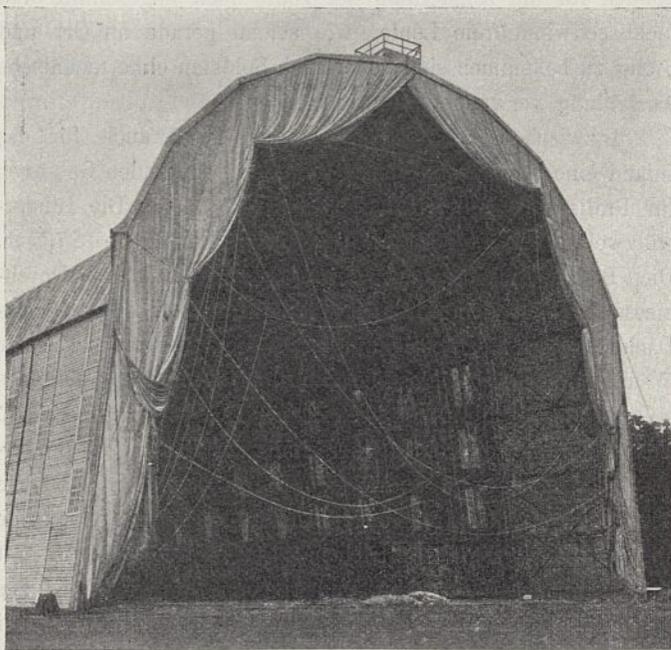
Versetzbare einschiffige Halle in Eisen.
